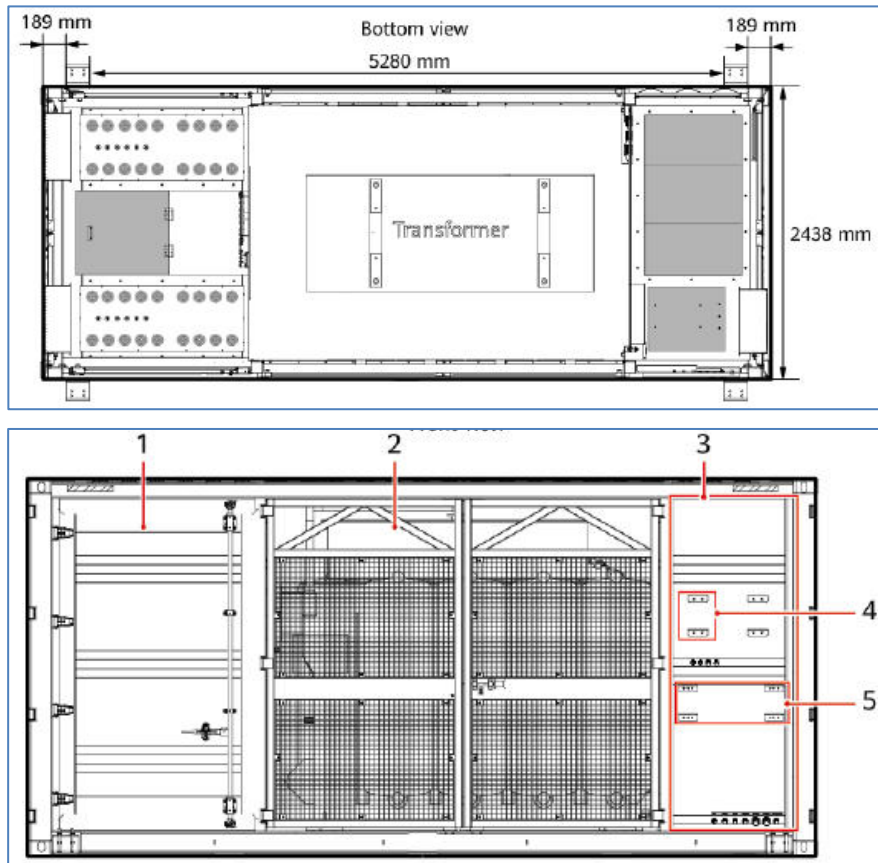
Planimetria e prospetto tipo dell'unità di trasformazione, con 1=Locale Bassa Tensione; 2= locale trasformazione; 3= locale Media Tensione.
